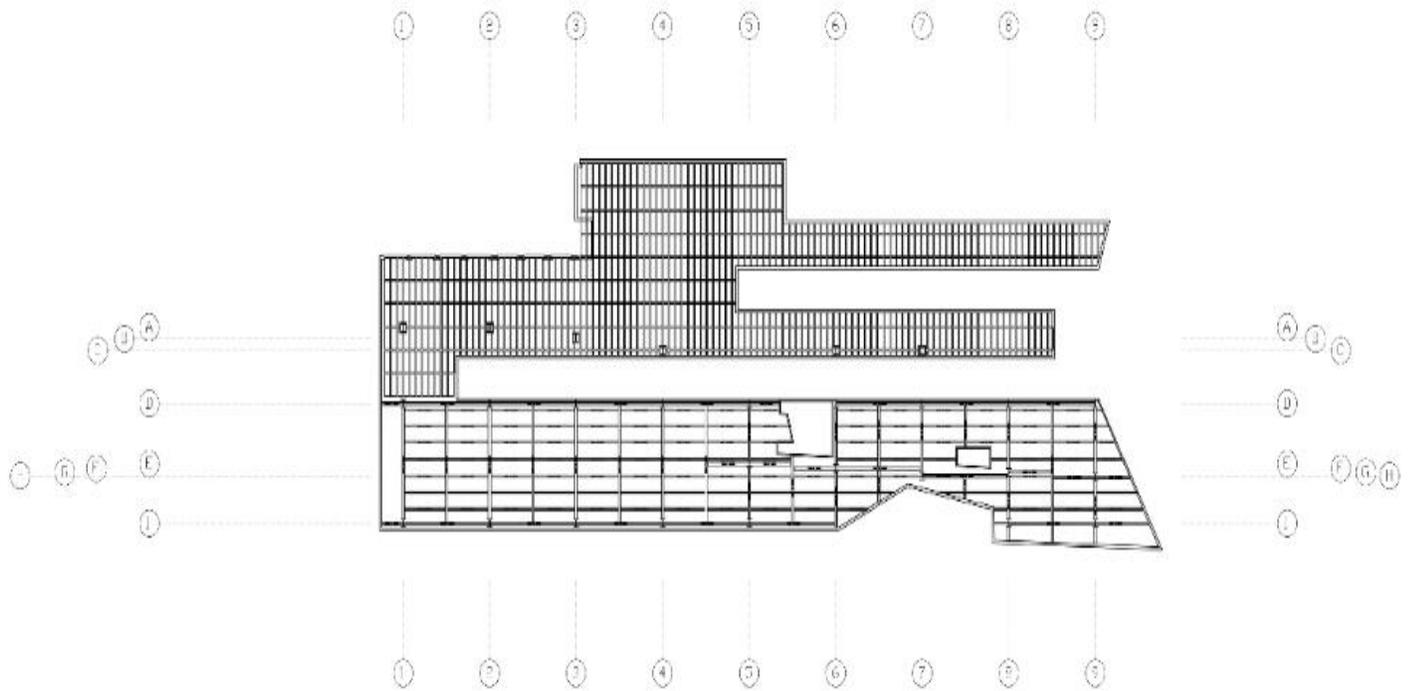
Plano Estructural Primer piso proyecto nuevo. Estación de la Sabana.
